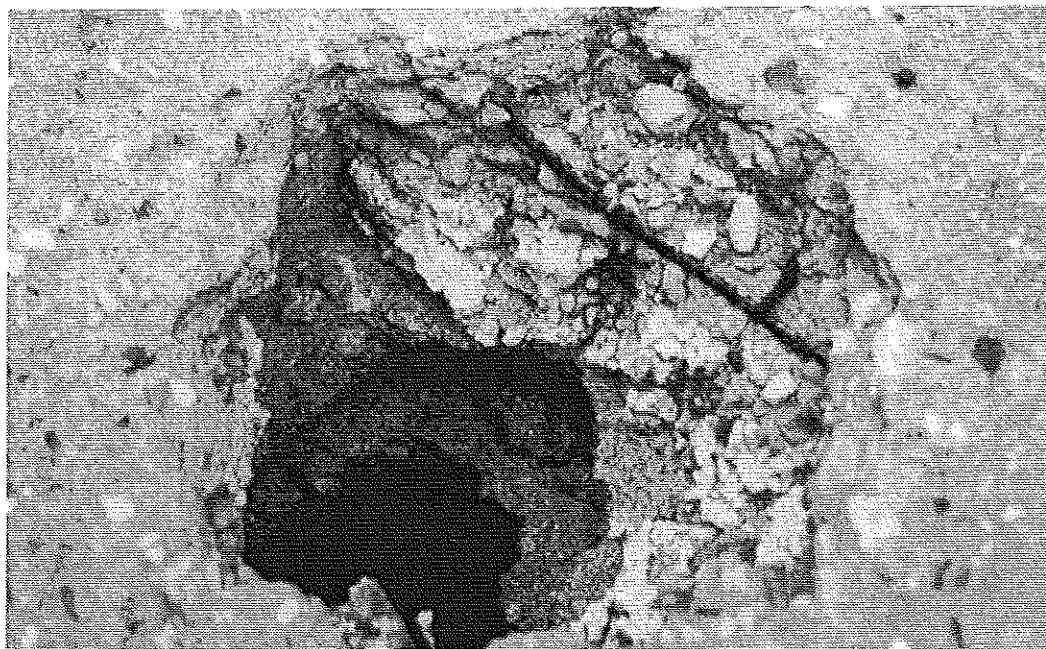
Sondage réalisé sur dalle plancher. La dalle de compression coulée sur entrevous et poutrelles est seulement armée d'un treillis soudé. © J. Putatti
